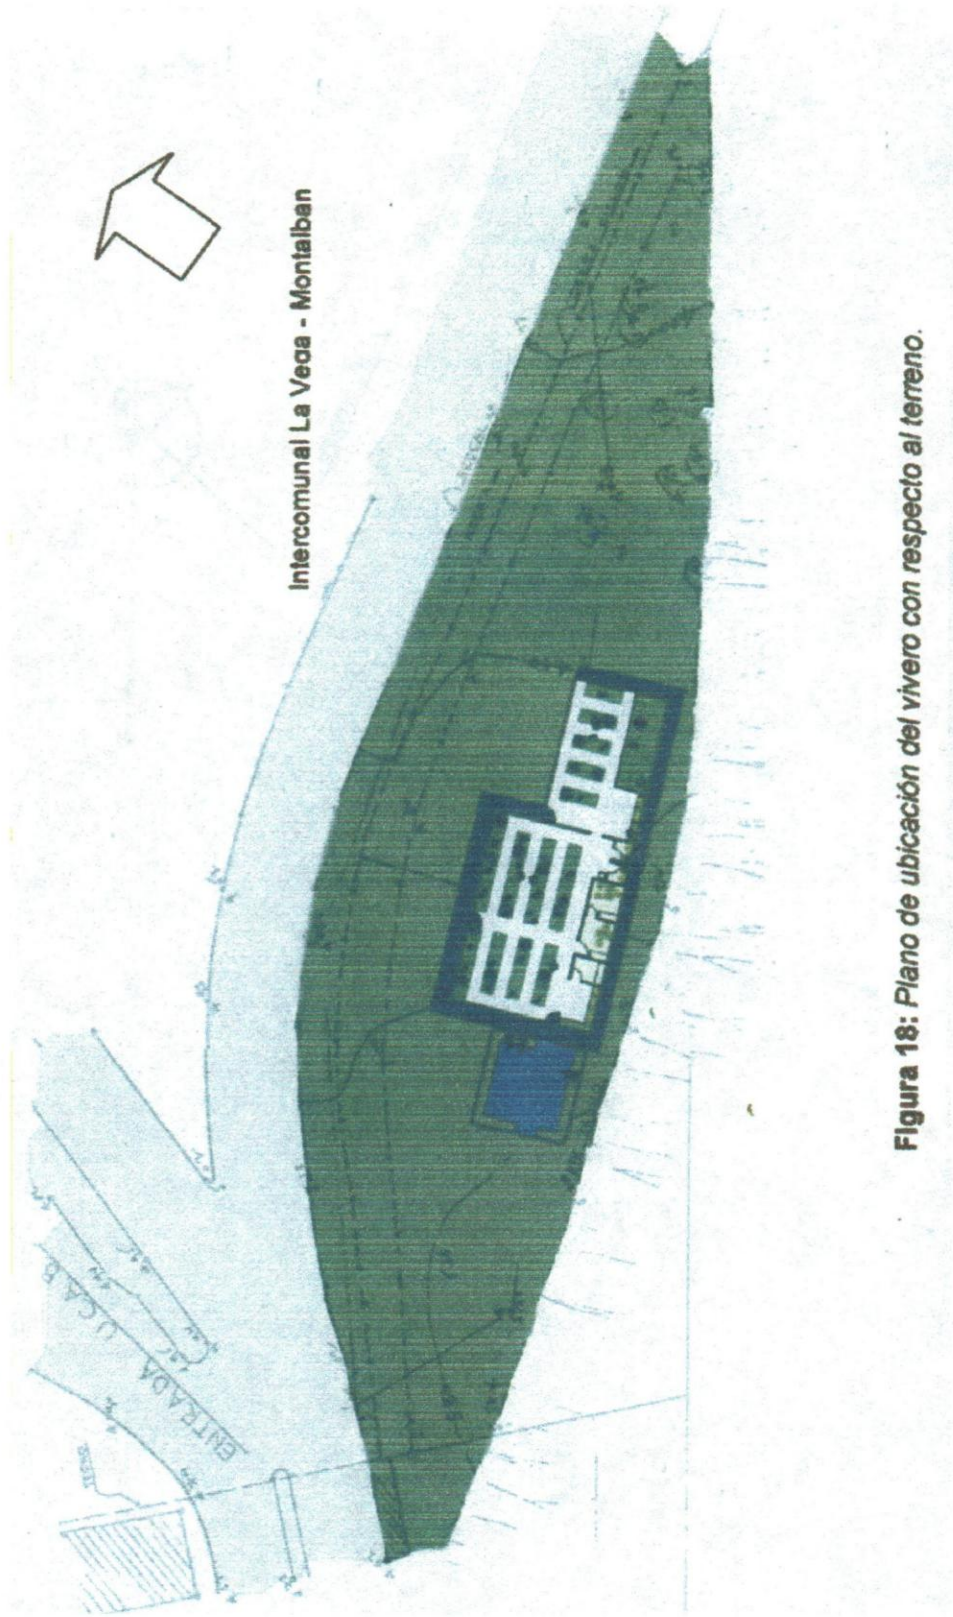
Plano de ubicación del vivero con respecto al terreno.
